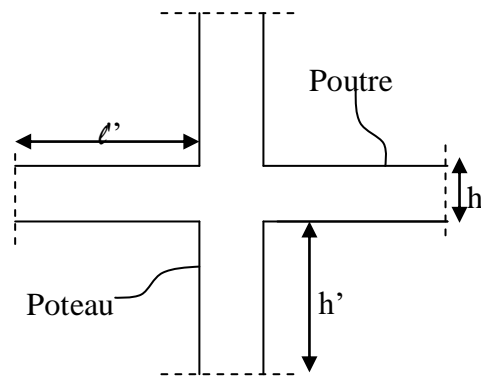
Zone nodale (nœud poutre-poteaux).
